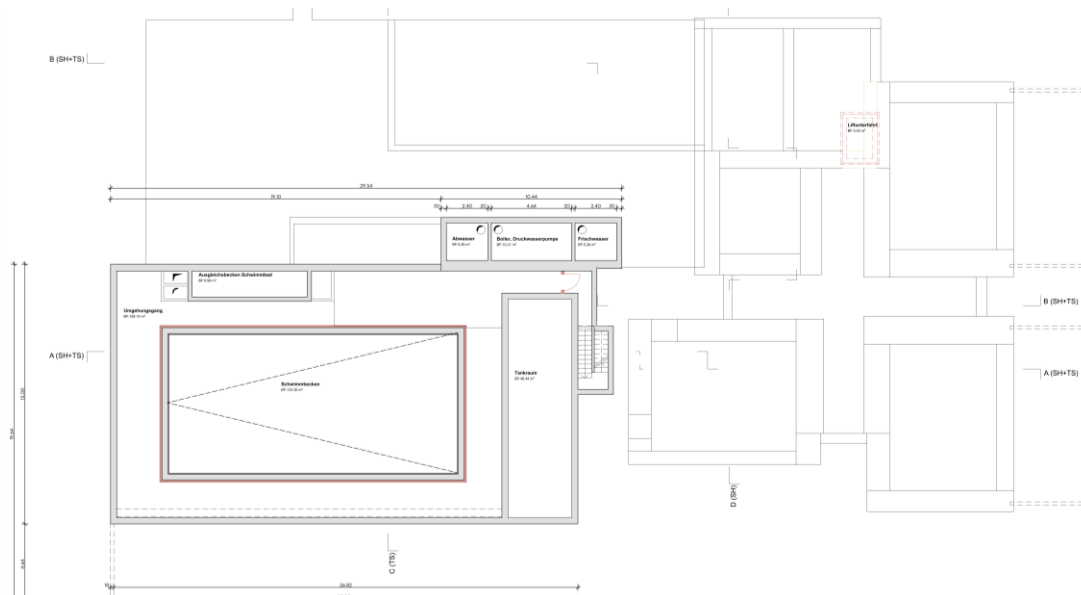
Grundriss 2. Untergeschoss, Gebäude 1 (links) und 2 (rechts)
